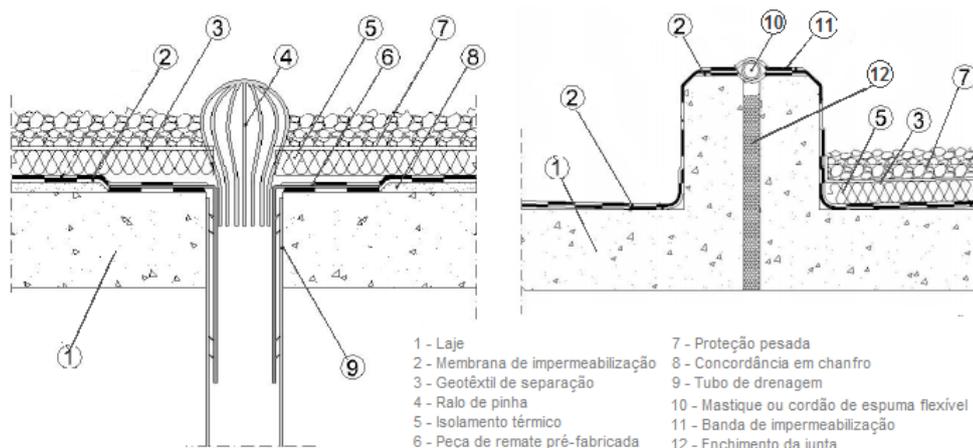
Pormenor de impermeabilização de um tubo de drenagem e de uma junta de dilatação sobreelevada (Aspim@ 2013)
